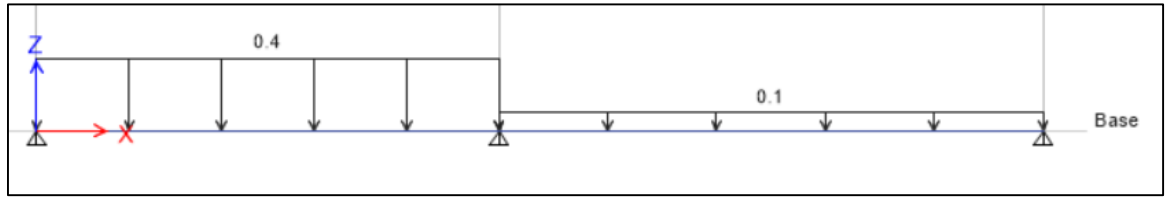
Carga viva de la vigueta 04 (Eje 6-8 y F-G)
